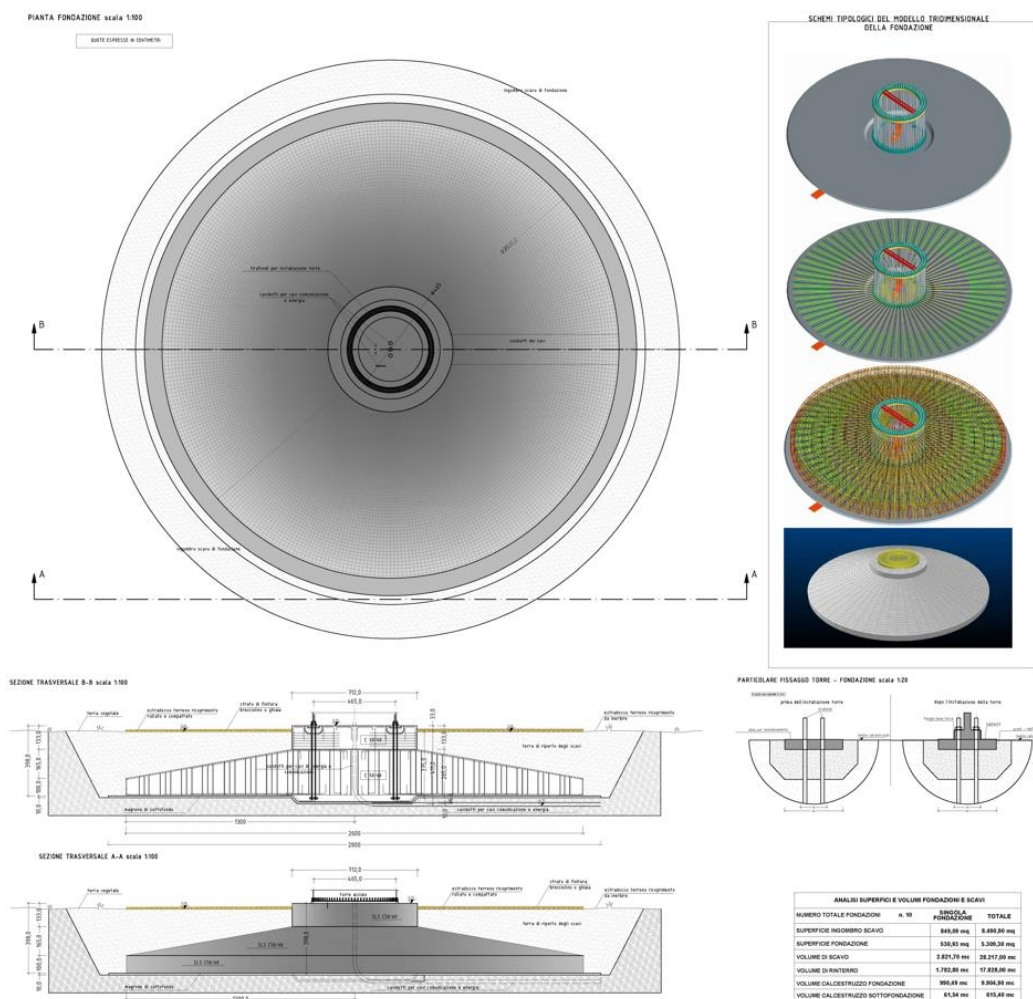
PIANTE E SEZIONE FONDAZIONE
